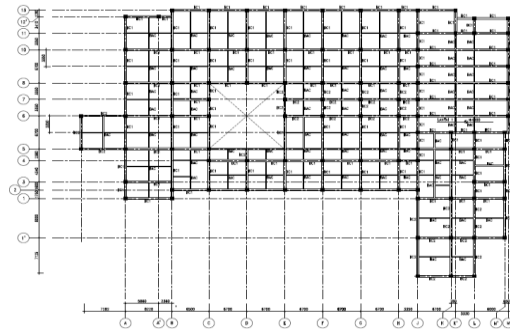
Denah kolom, balok dan pelat lantai pada basement
